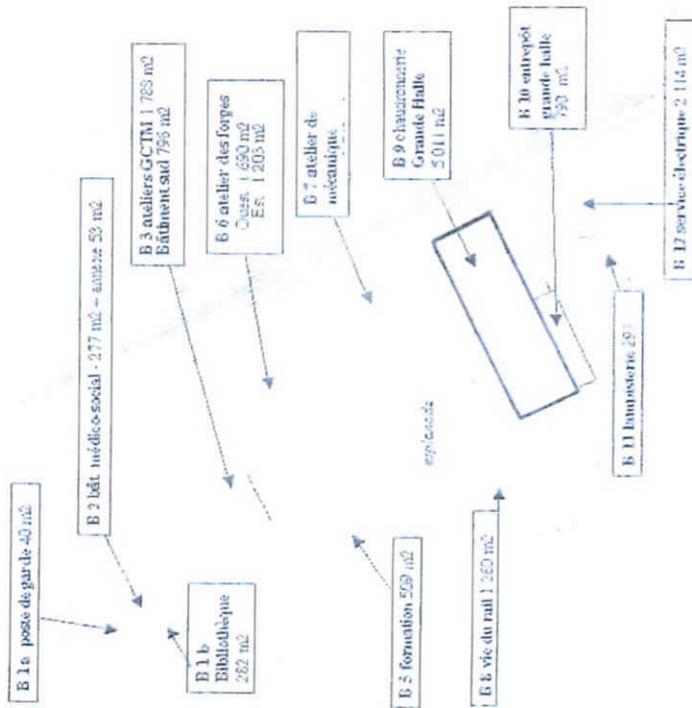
Les bâtiments existants sur le site de la ZAC des Ateliers
